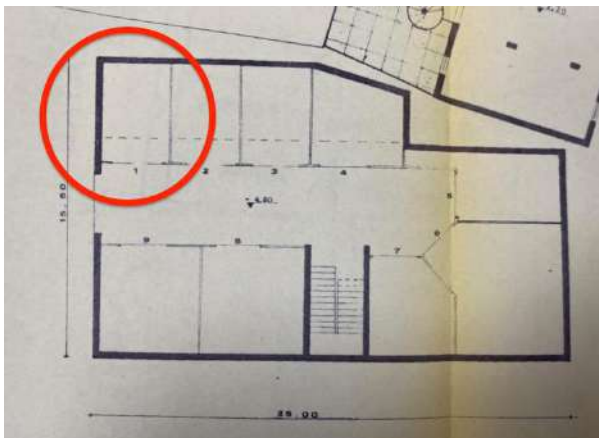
Grafico planimetrico di cui alla Concessione edilizia prot. n. 2599/1988 (cfr. All. 7c3)
